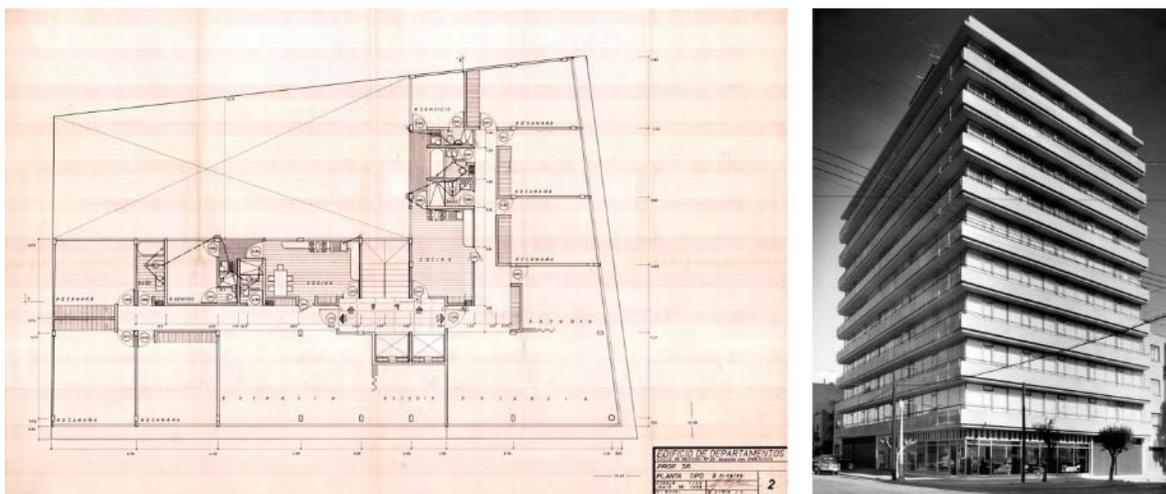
Plano planta tipo, julio 1958, y vista de la fachada del edificio ubicado en Mexicali núm.20, fotógrafo Héctor Mejía Arriaga, ca.1959
